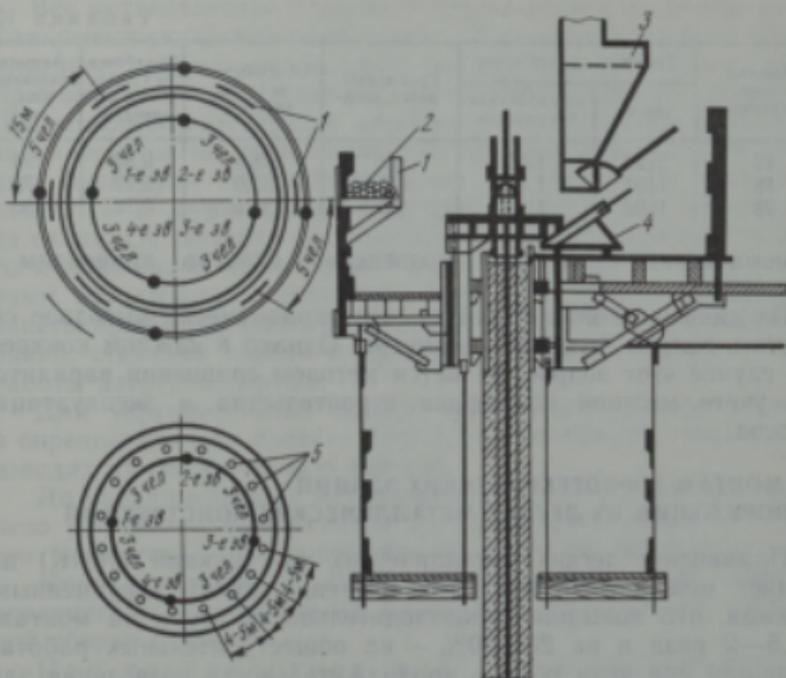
Организация бетонных и арматурных работ на полке:
